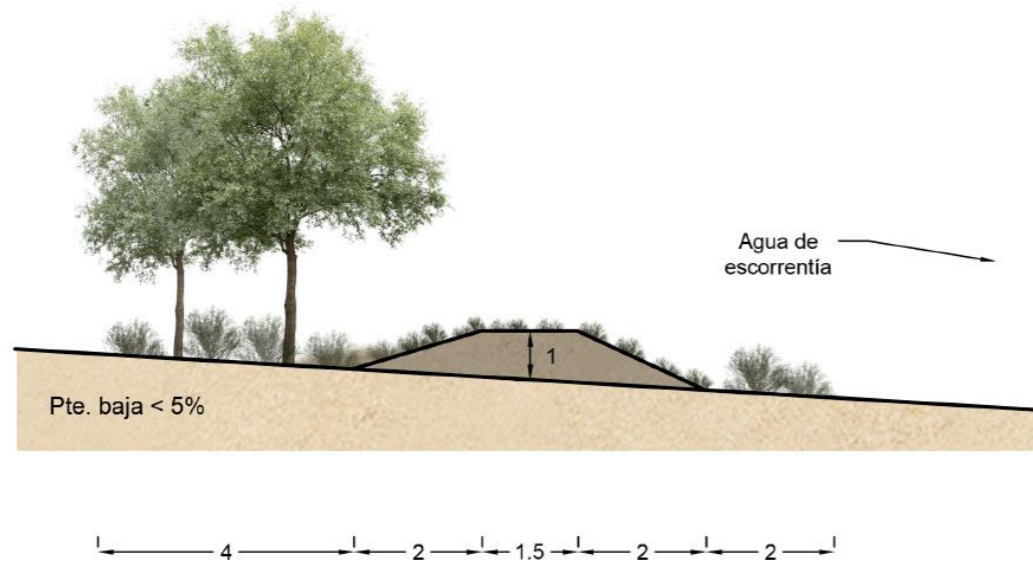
Detalle de sección transversal de ribazo tradicional.
